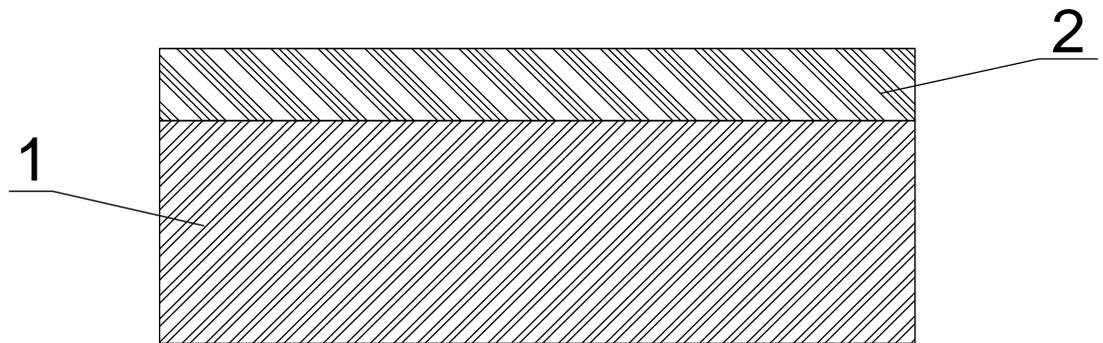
Горищне перекриття: 1-залізобетонна плита, 2 – керамзитовий гравій.
